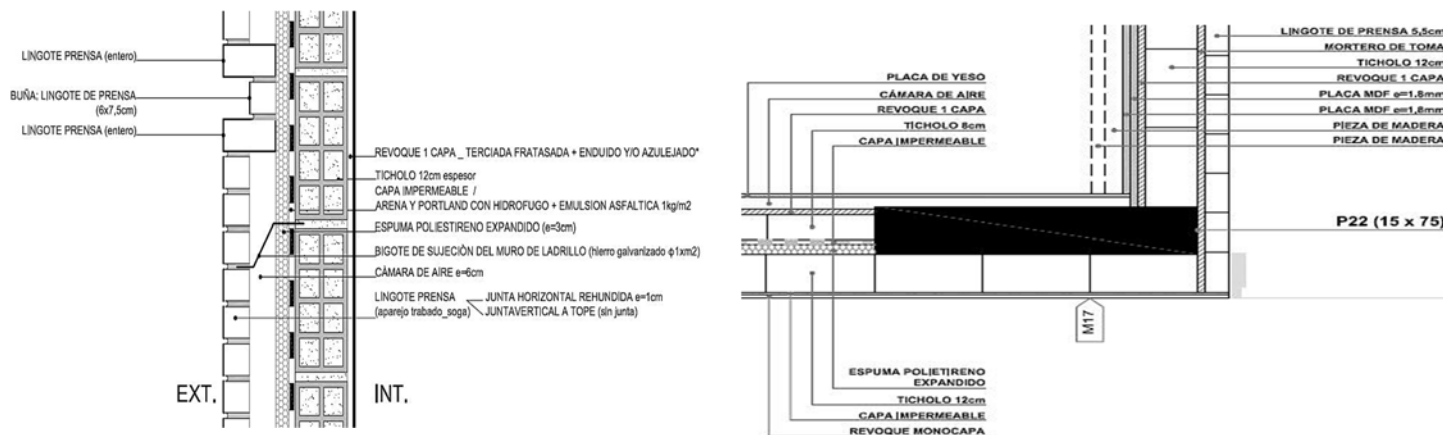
Instituto de Producción Animal | Detalle en corte de muro de fachada, terminación ladrillo visto y detalle en planta de muro de fachada, terminación revoque monocapa.. Gráfico gentileza Arq. Daniel Calzada.
